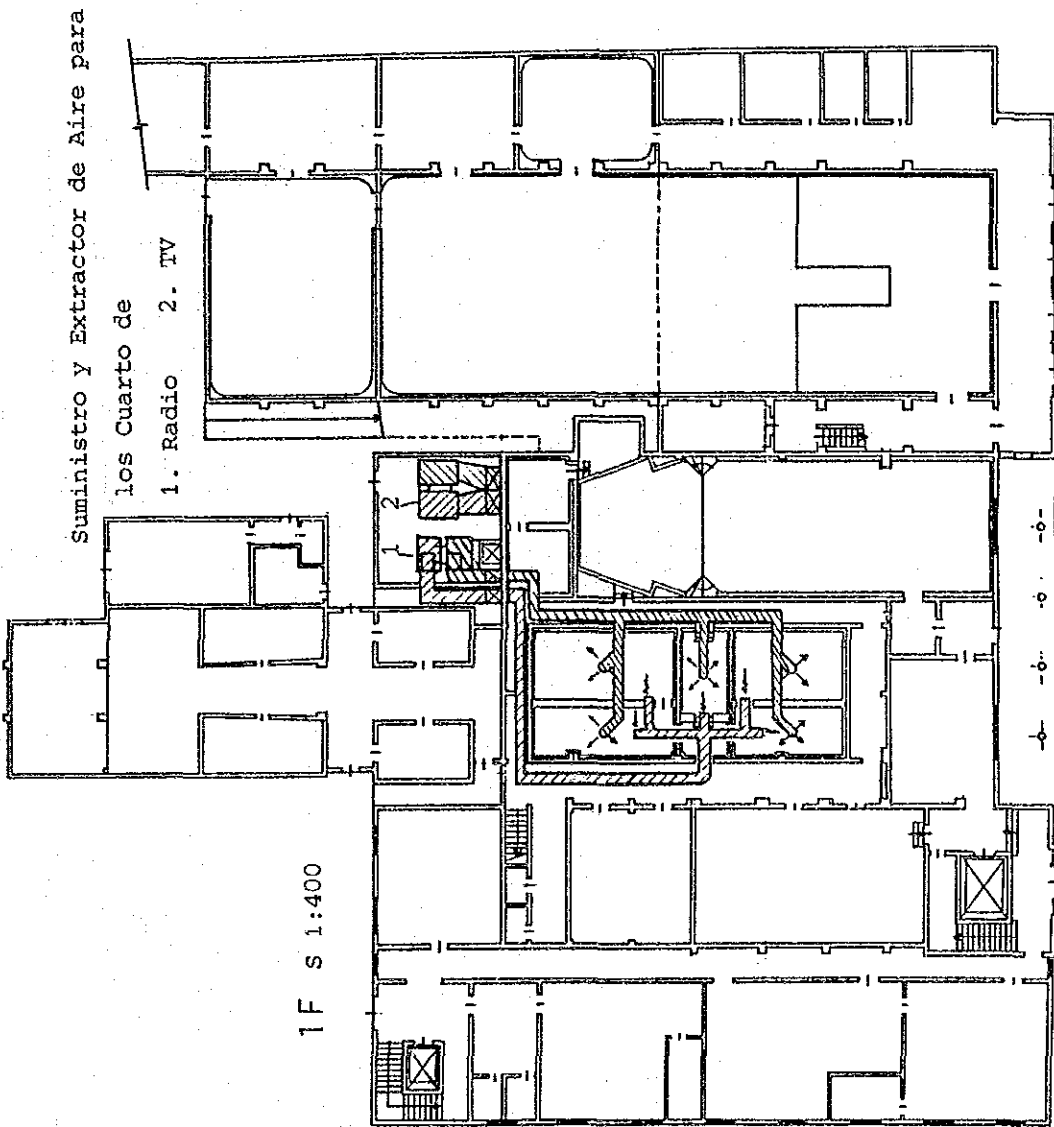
Plano del Aire Acondicionado (Primer Piso)
